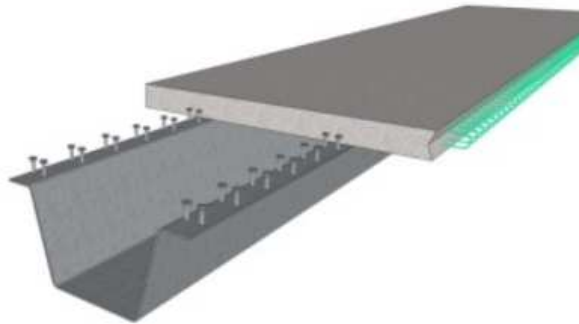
Unidad modular, viga metálica de chapa doblada y mesa de compresión. The Short Span Steel Bridge Alliance (SSSBA)
